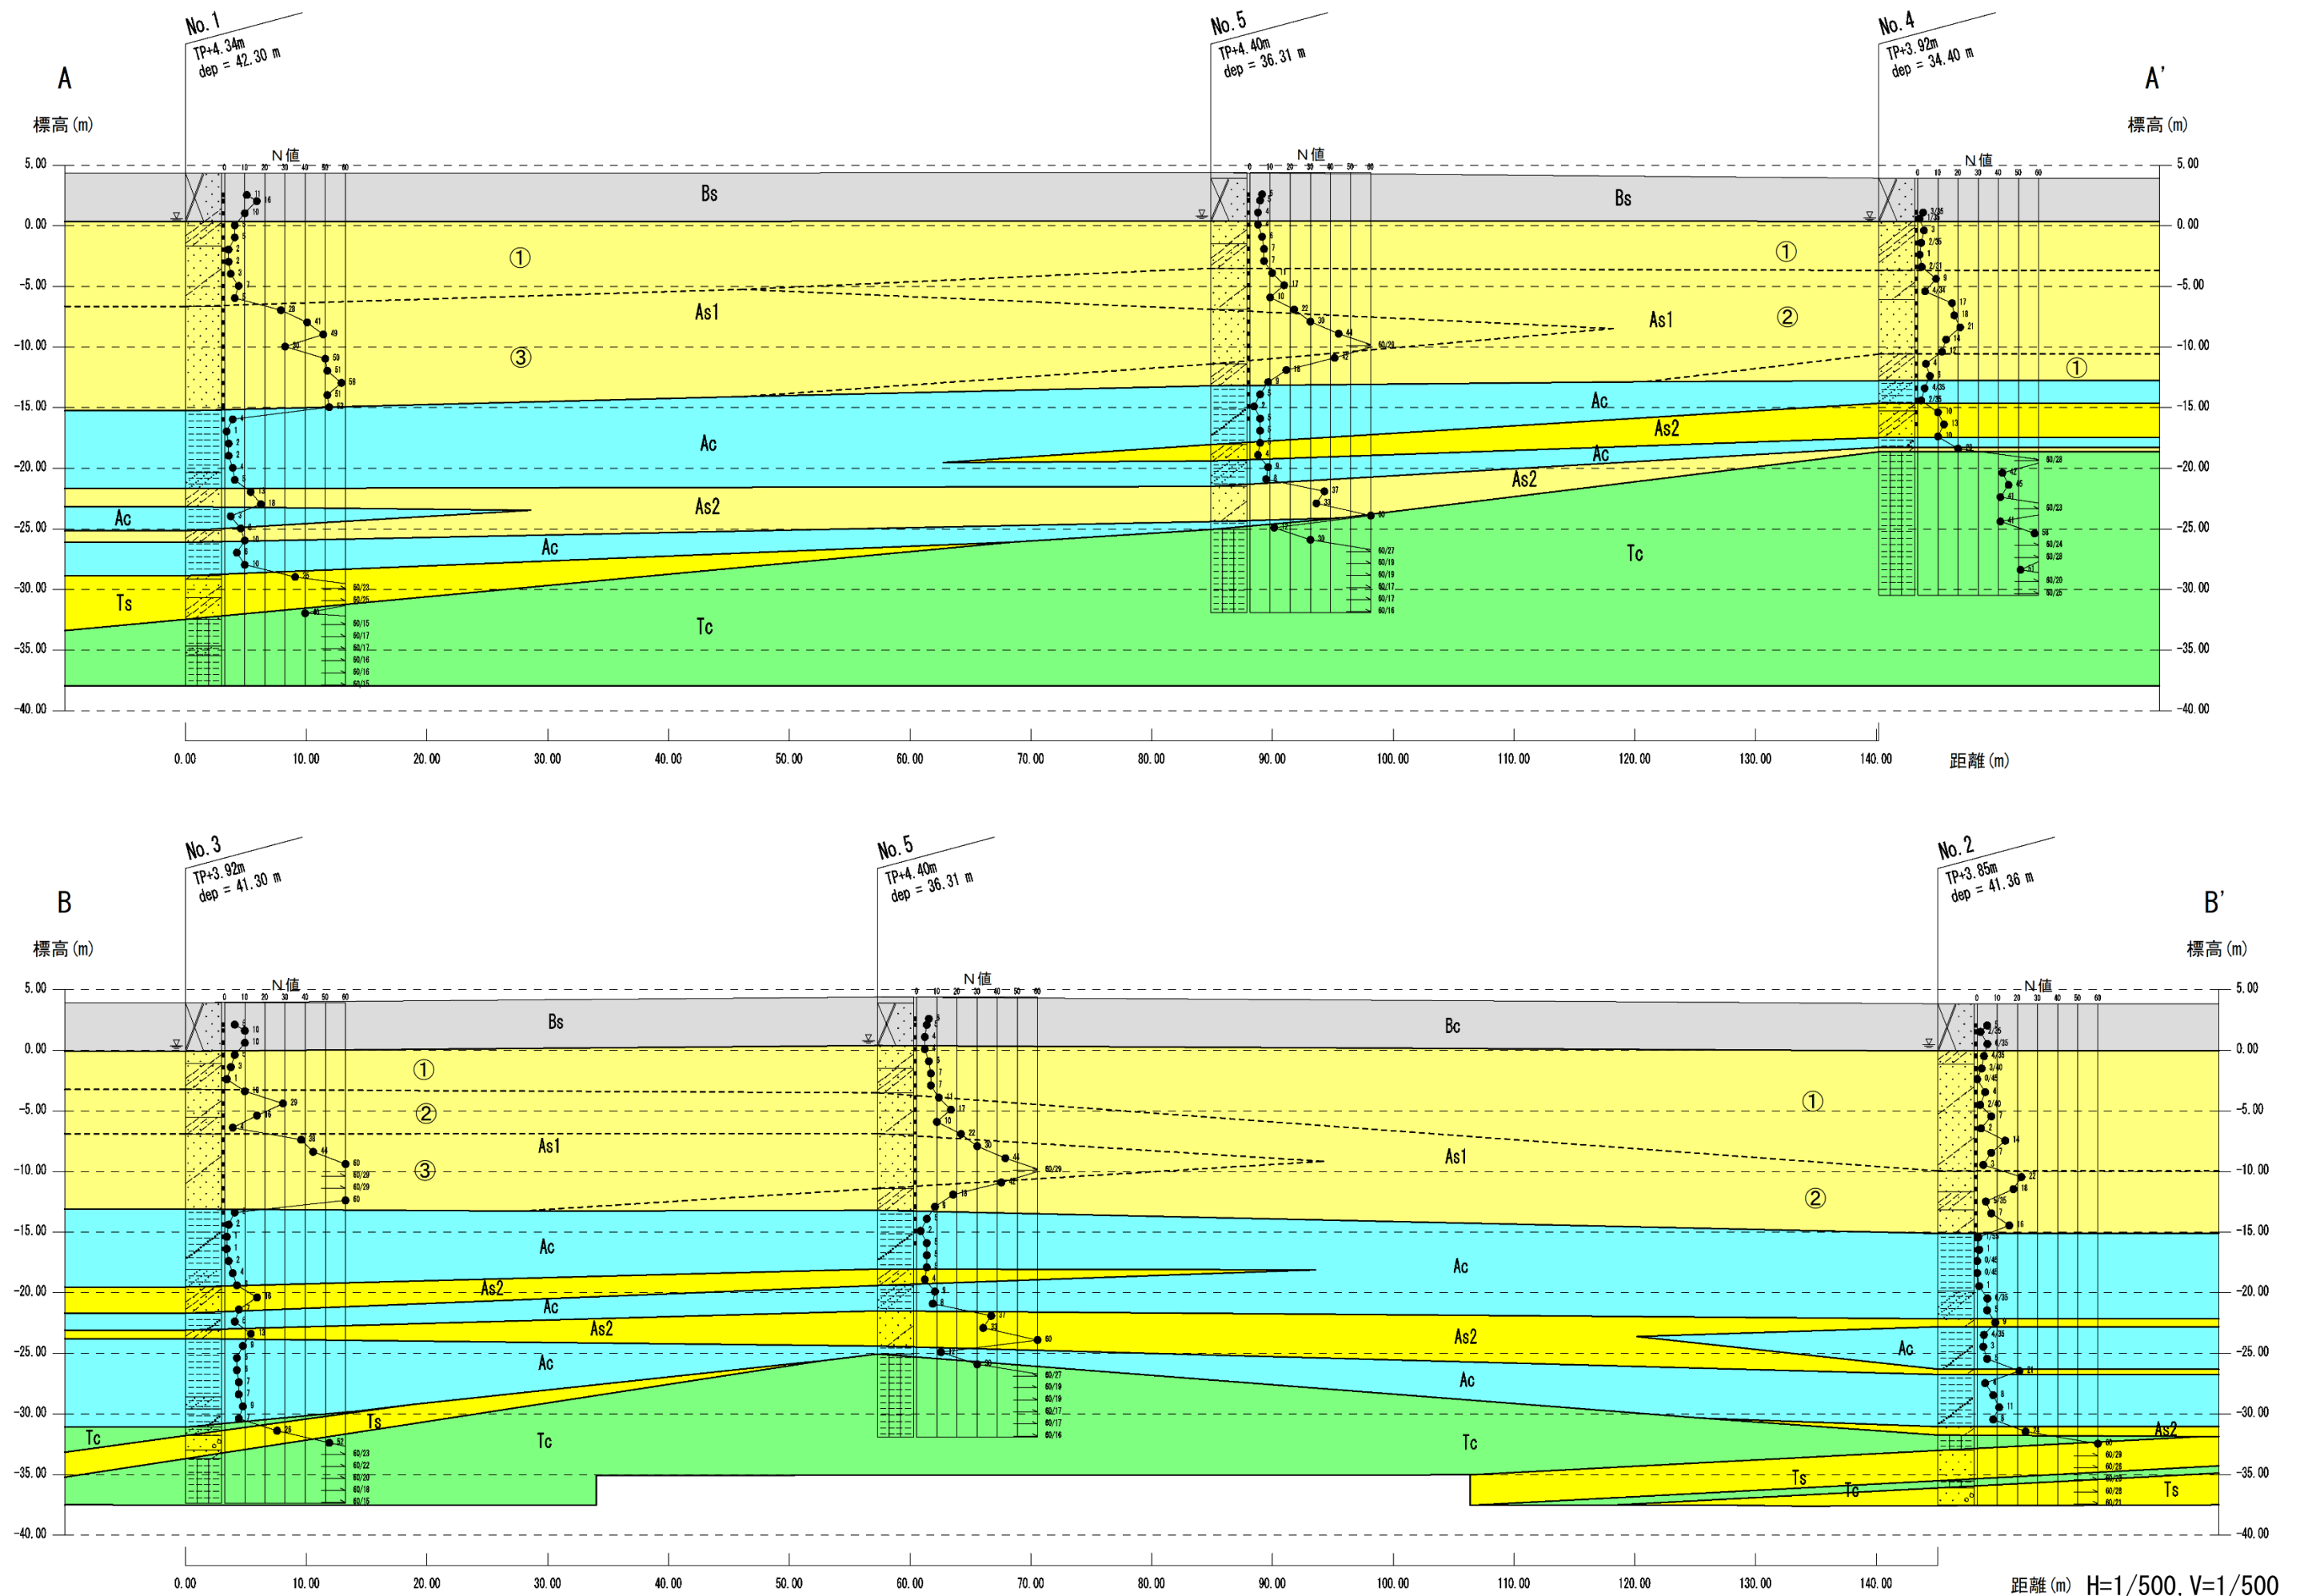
地質断面圖 (A—A' B—B' 断面)
